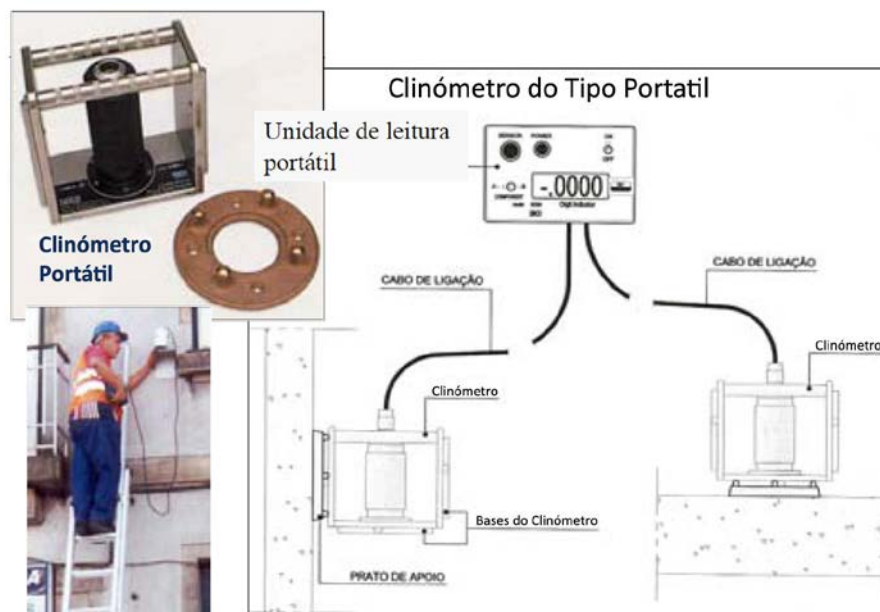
Clinómetros instalados em estruturas (Pinto, 2009).
